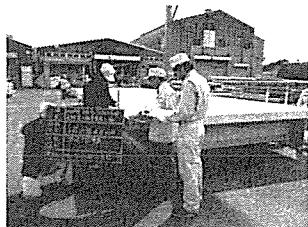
仮組検査状況① 写真-2 仮組検査状況②
